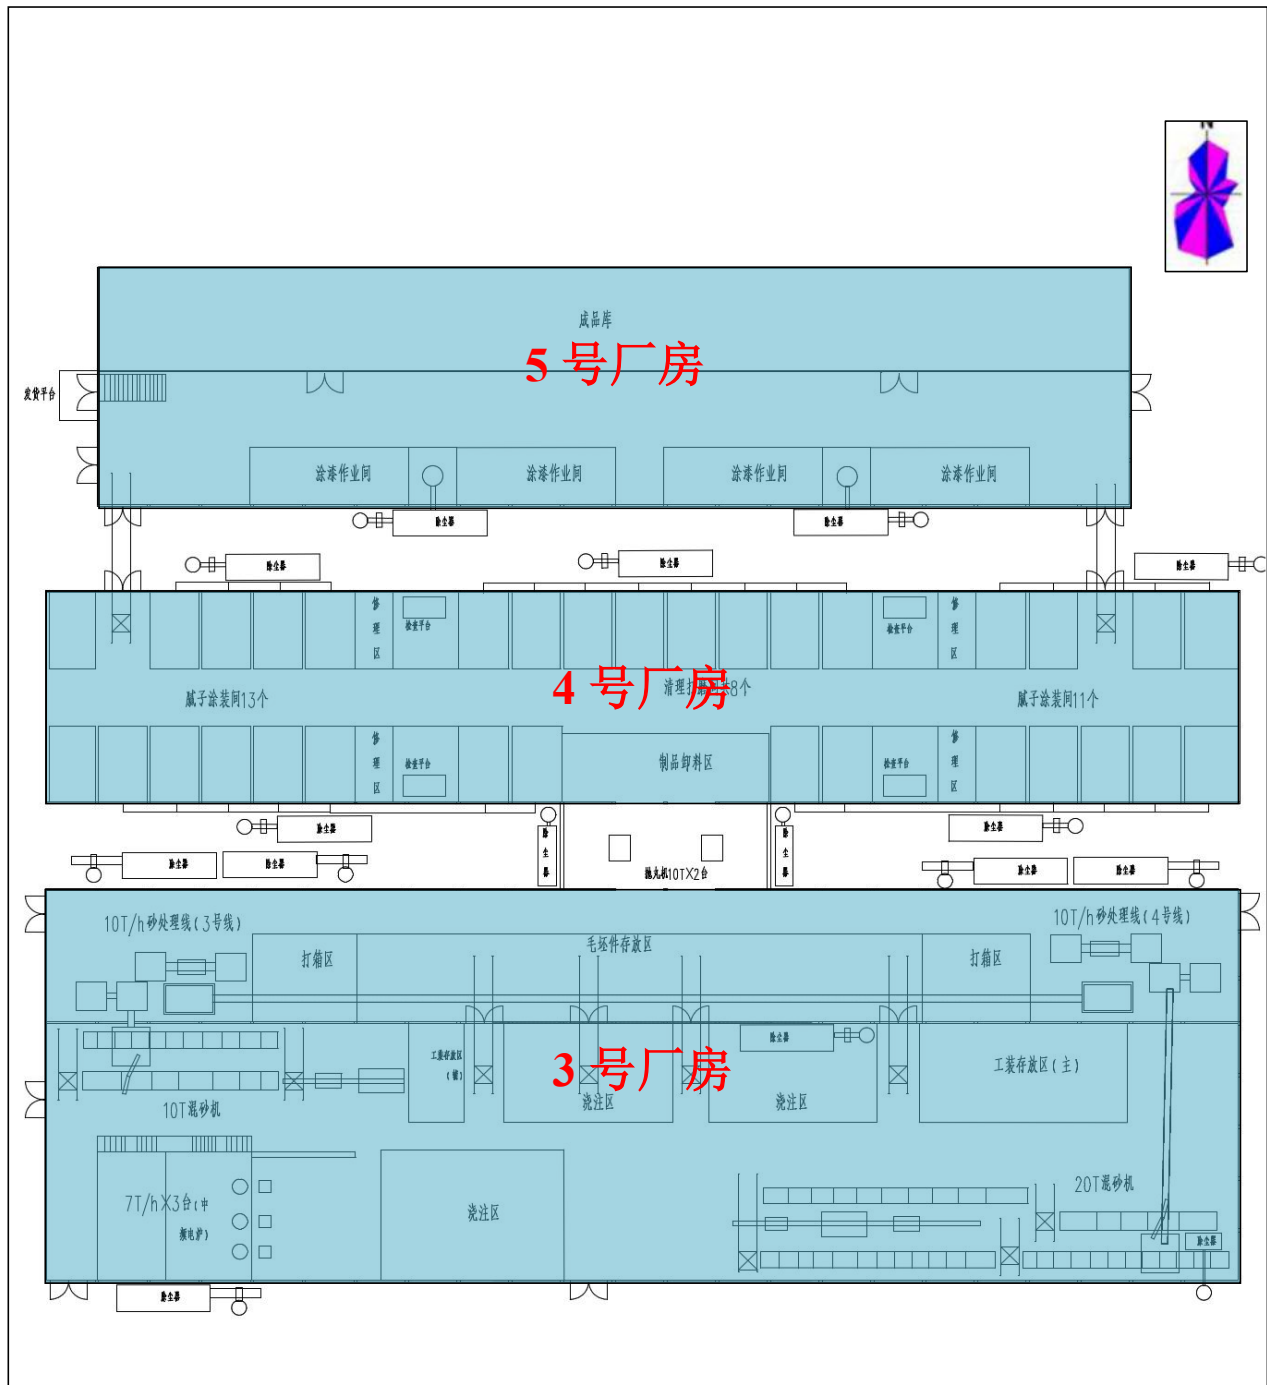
3 号、4 号、5 号厂房平面布置图
